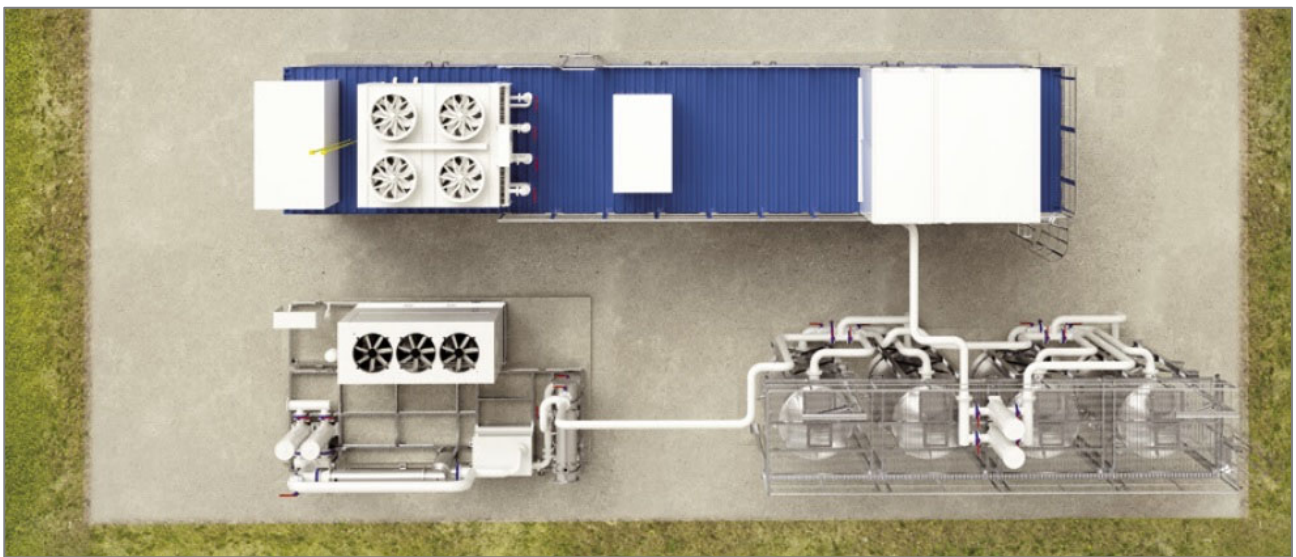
Vista planimetrica tridimensionale di impianto di Upgrading simile a quello in progetto
